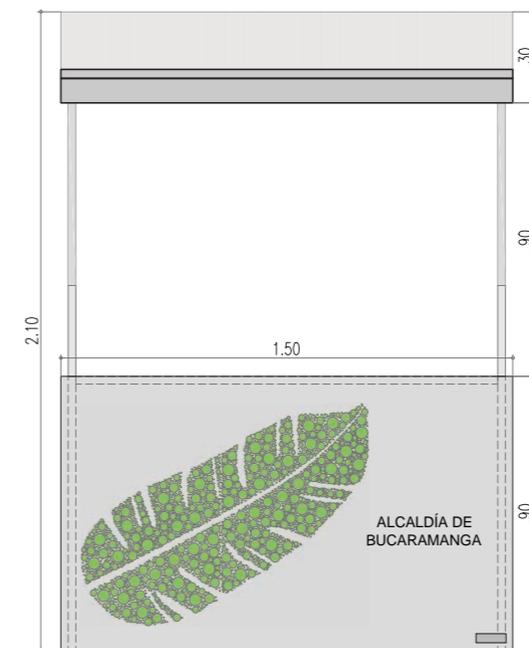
Fachada puesto de venta semi-estacionario tipo 5. Esc 1:25
